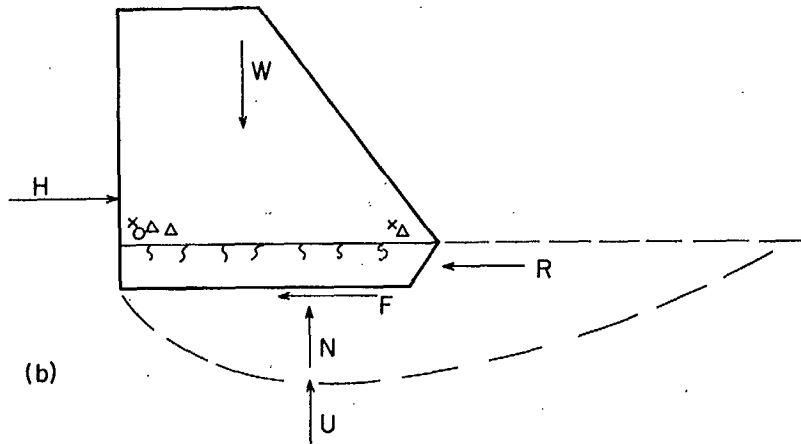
Fondation d'un barrage avec des zones faibles et certaines mesures de construction qui peuvent être prises.
